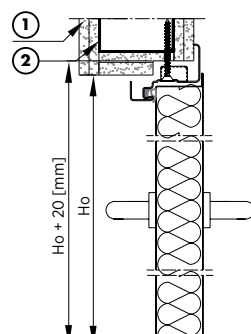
Montage mural d'un bloc-porte à deux battants avec bâti angulaire - coupe verticale
